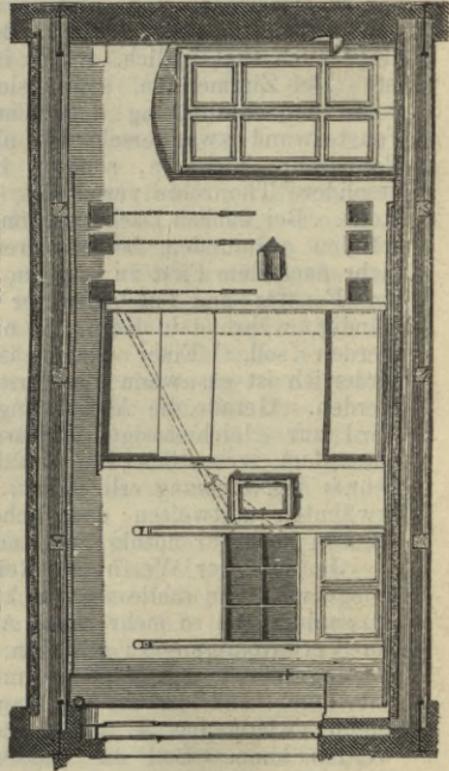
Querschnitt nach C—D des Grundrisses.
